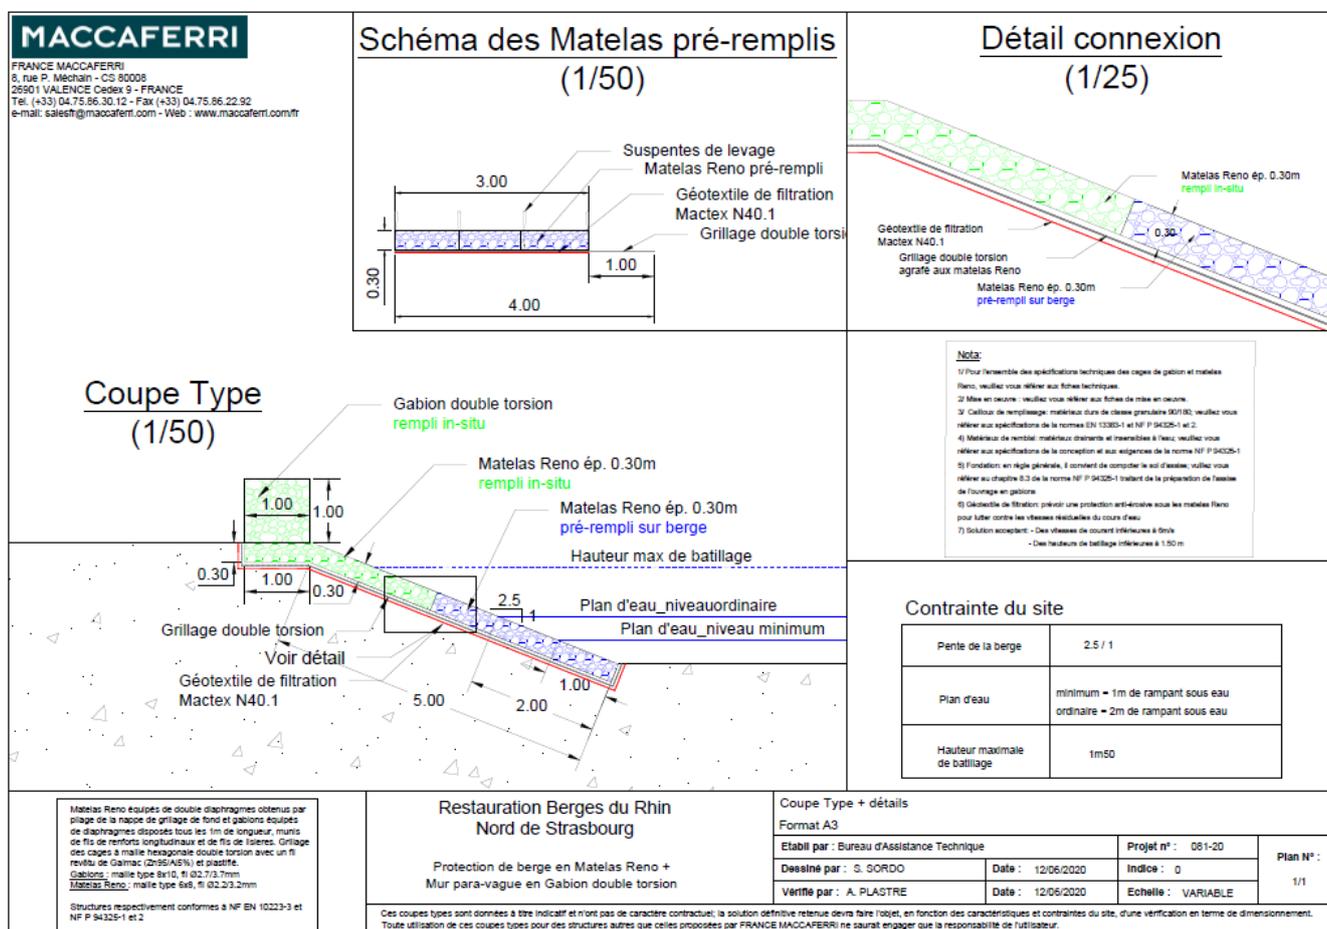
Coupe type de la protection (source : DLE, VNF 2021)
